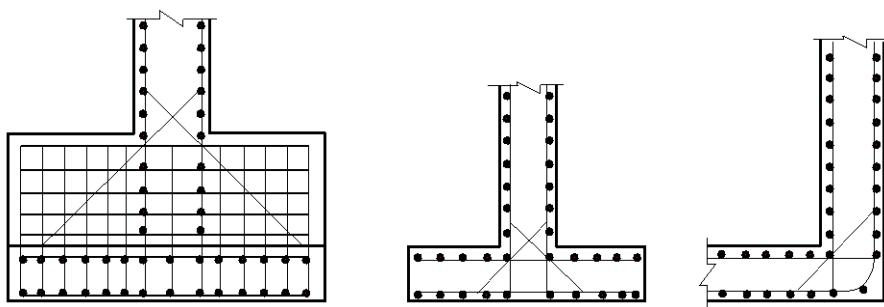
門柱と堰柱との結合部、堰柱と床版との結合部の配筋
